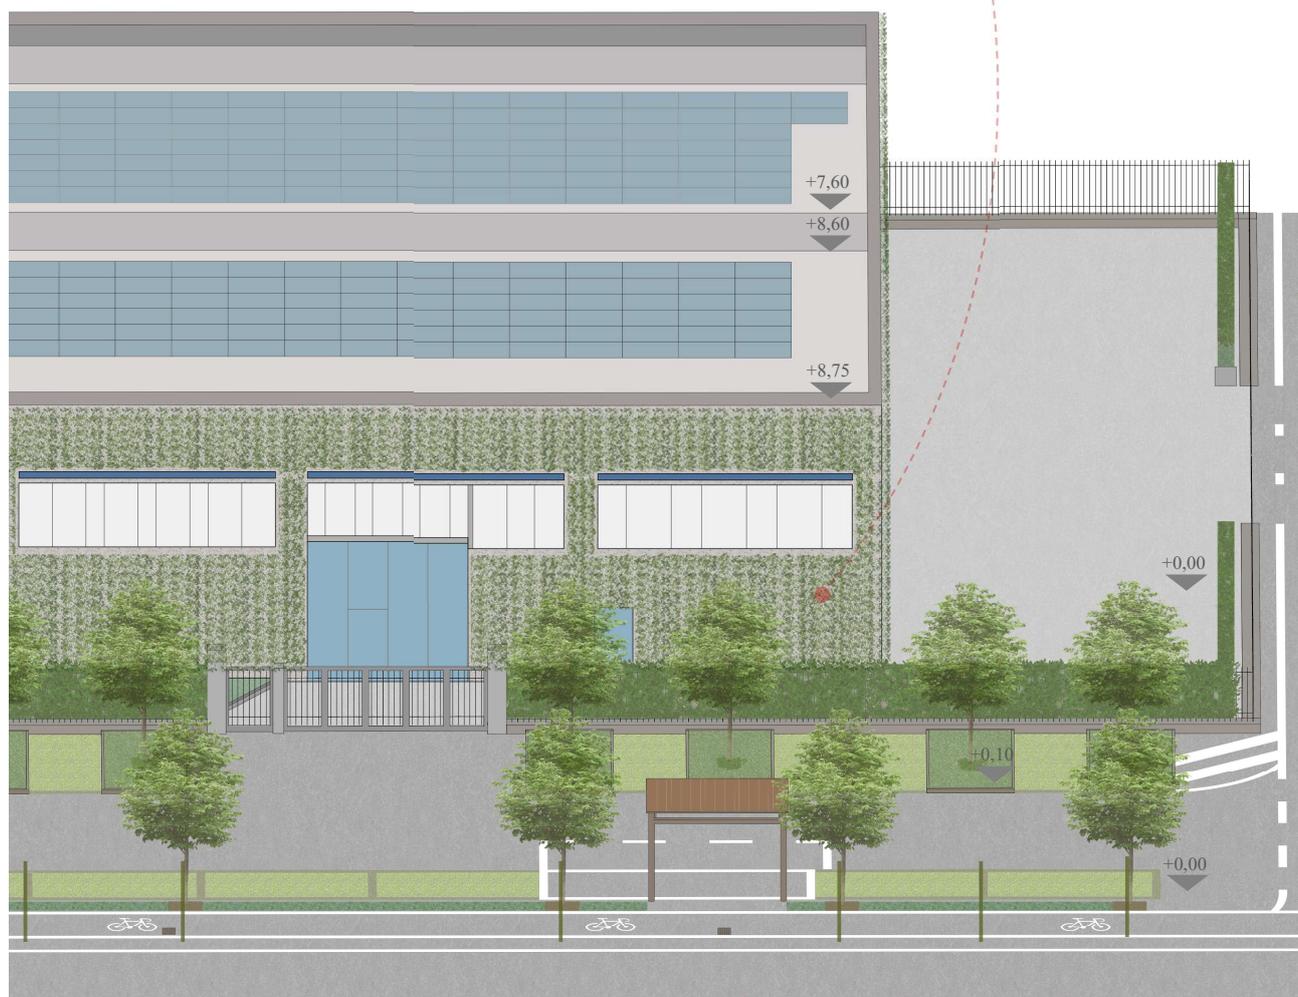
Vista dell'azienda (fronte sud-ovest) con inserimento della proposta di progetto della parete verde.
